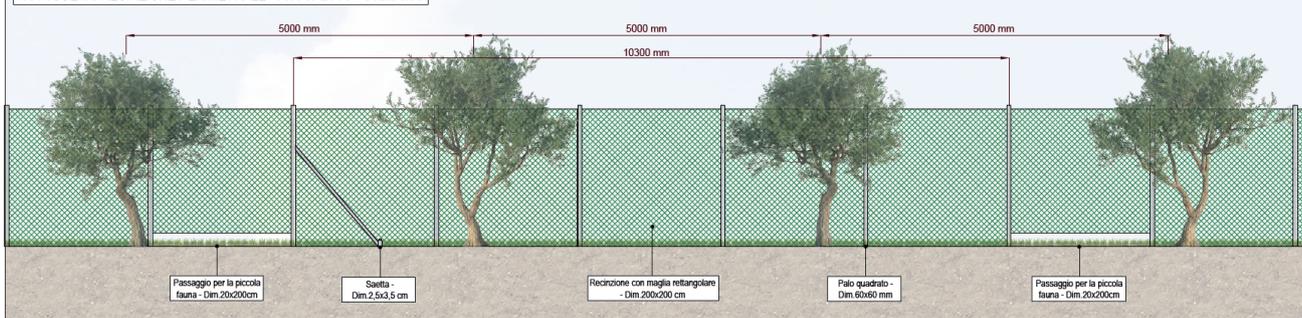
Particolare recinzione perimetrale con passaggio piccolo fauna
